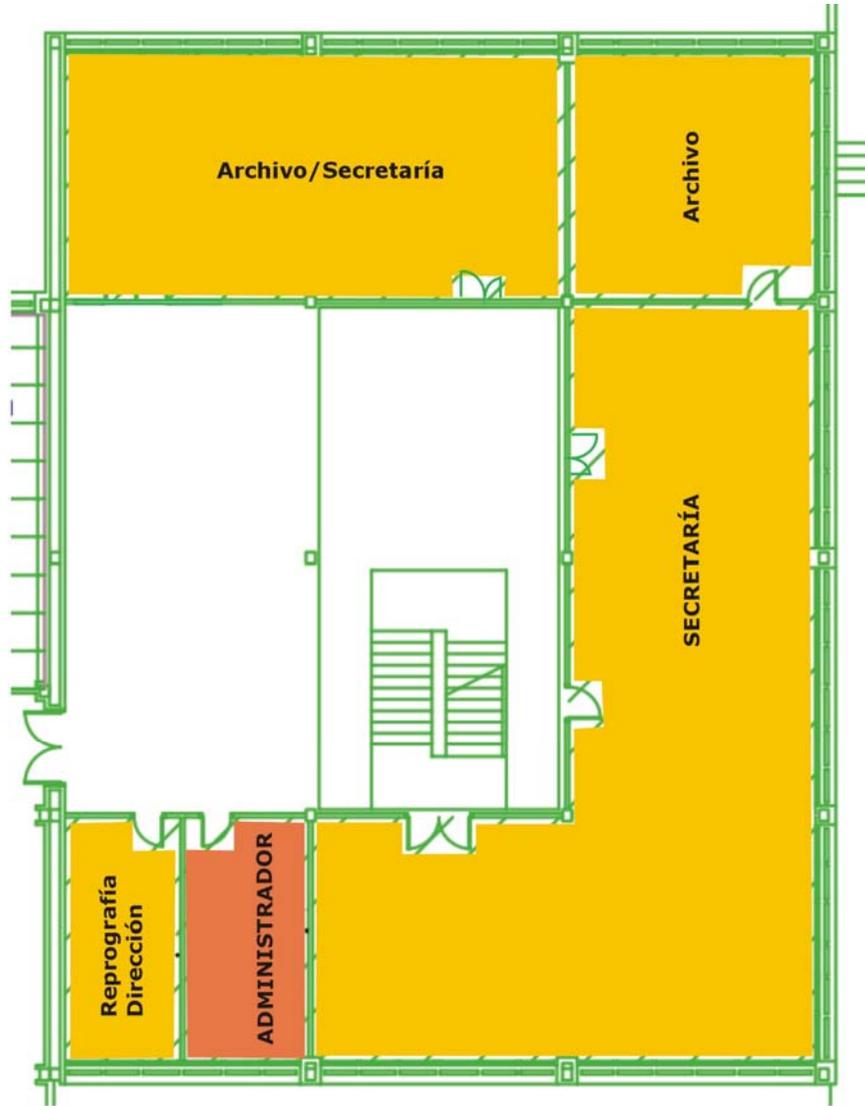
5. Plano de propuesta de actuación en Ed. Torres Quevedo (planta baja)
